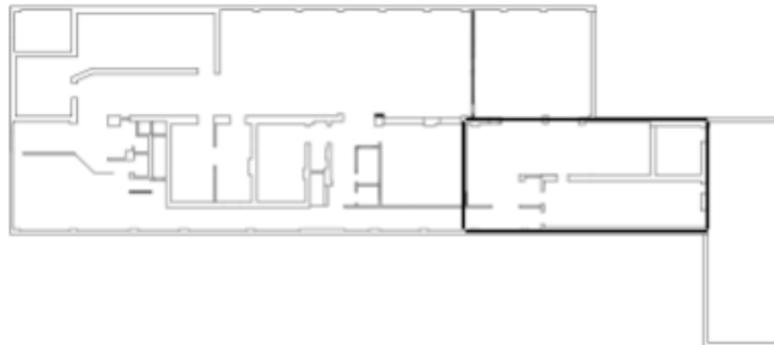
Planta baja - Recuadro de layout a detallar.
